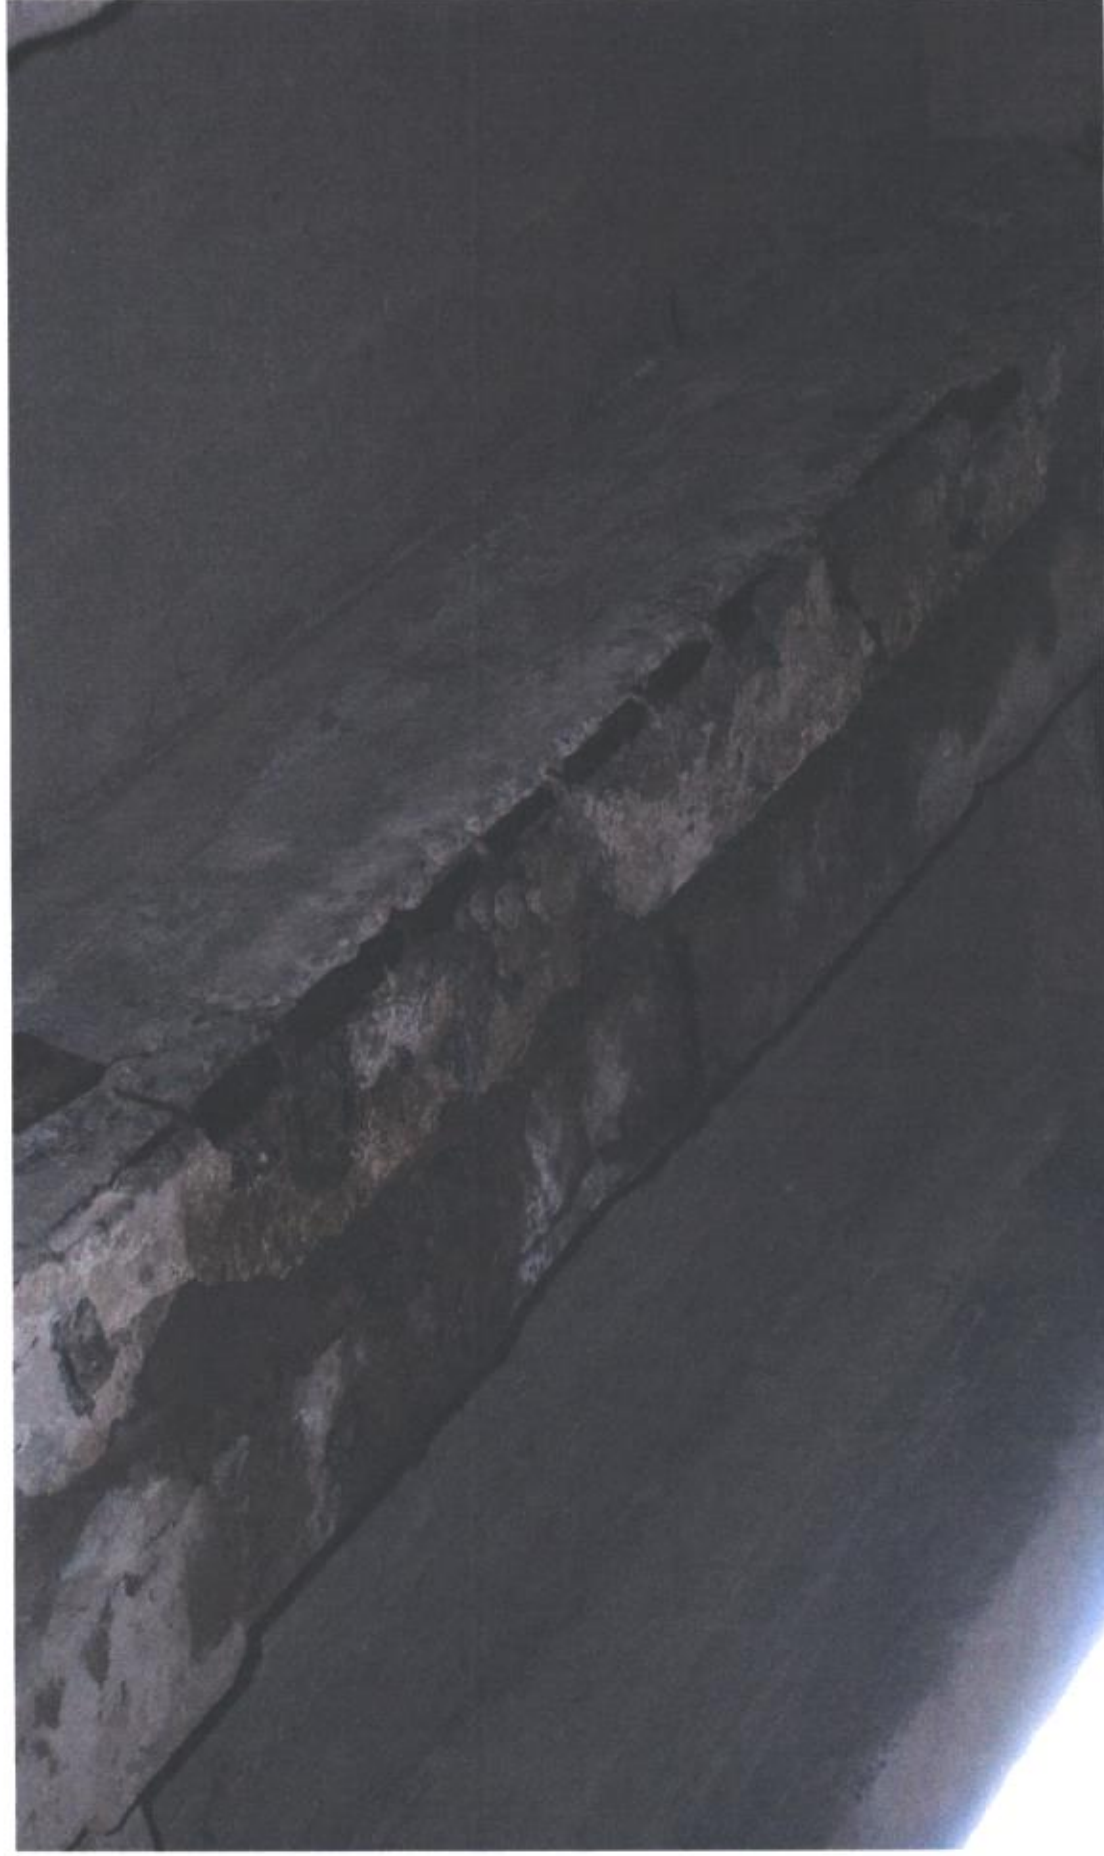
Разрушение защитного слоя бетона ребер балок с оголением и коррозией арматуры
